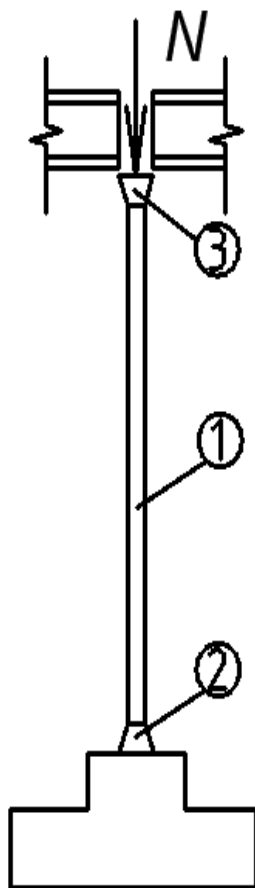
Схема центрально-стиснутої колони [3]: 1 – стержень (суцільний або наскрізний); 2 – база (башмак); 3 – оголовок
